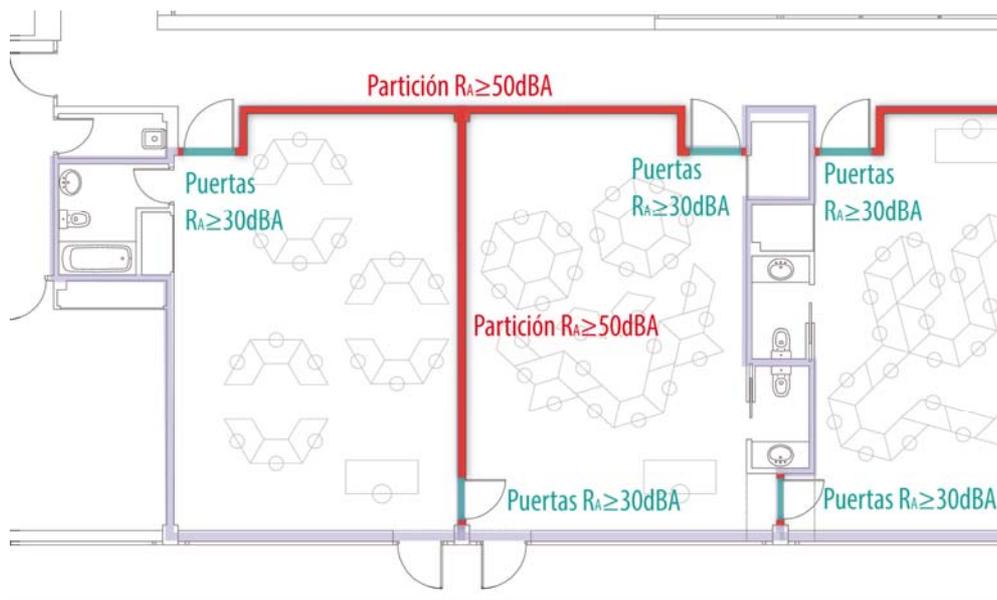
Detalle planta de aulas con indicación de exigencias aplicables a las particiones con puertas y a las puertas.
